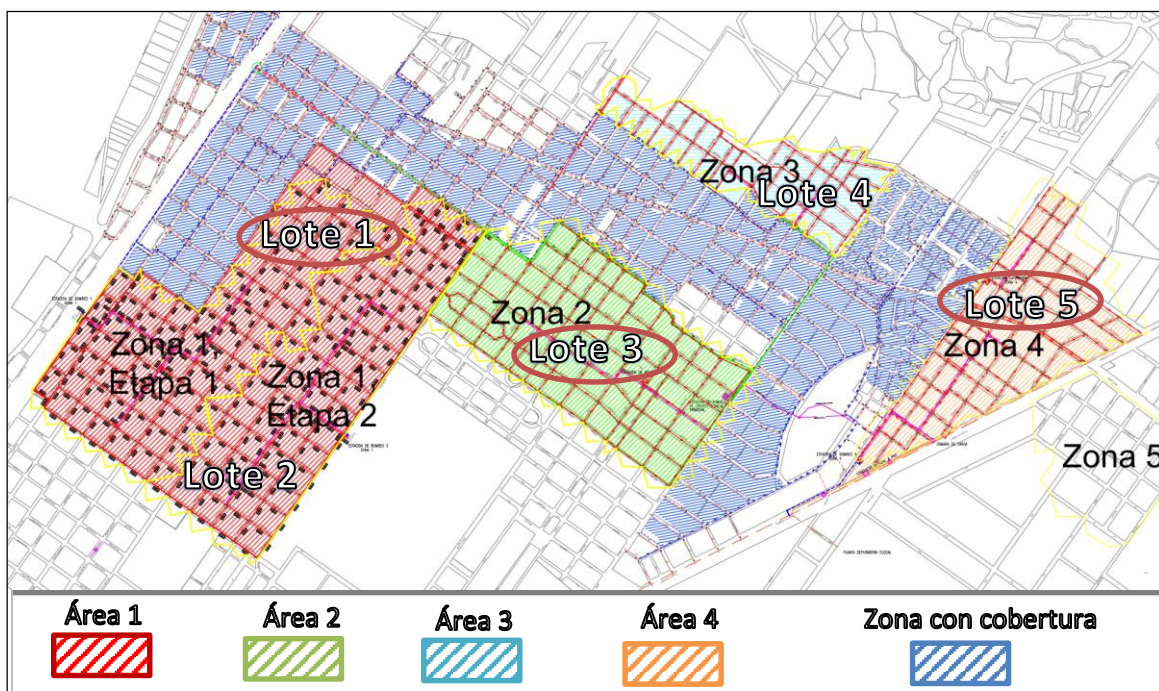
Áreas y Zonas, contempladas en el Proyecto (la Zona 3 y 5 no se realizan en este proyecto).
